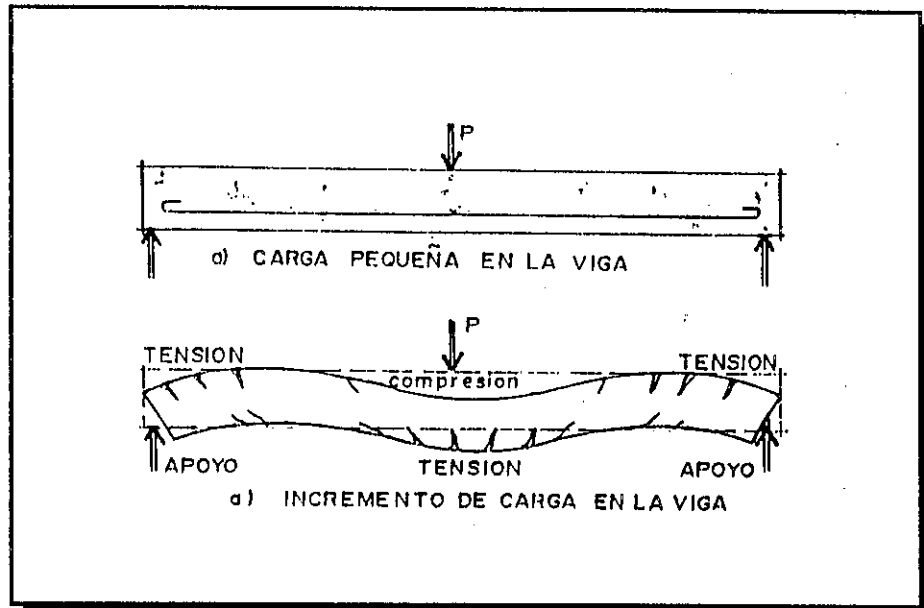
DEFORMACION DE UNA VIGA A) CON CARGA PEQUEÑA, B) DEFORMACION CAUSADA POR INCREMENTO DE CARGA HASTA SU AGRIETAMIENTO.
